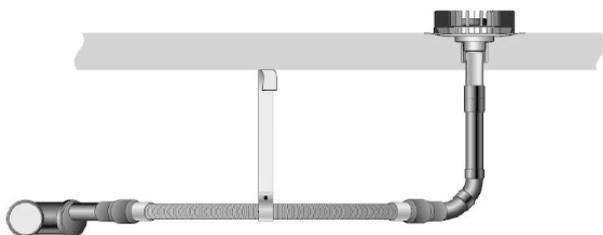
Fixação da mangueira flexível quando instalada horizontalmente.
